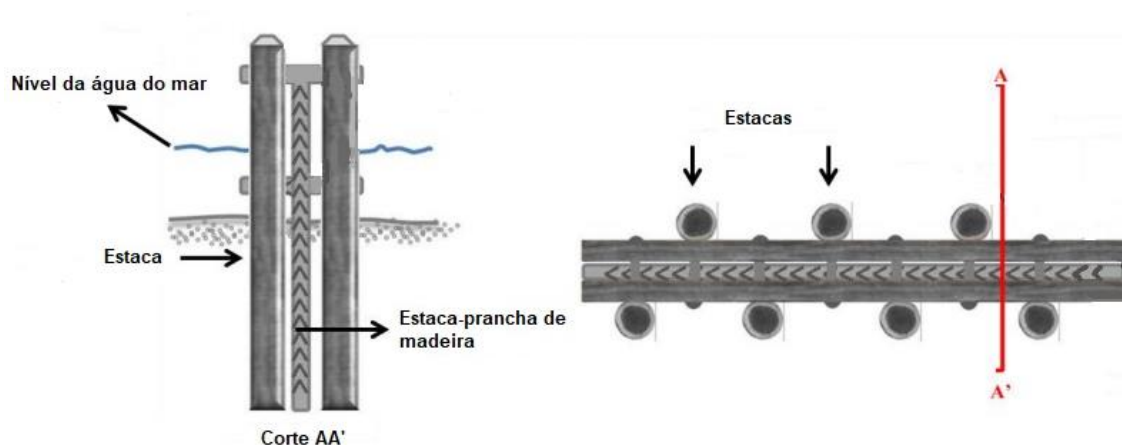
Perfil transversal e configuração em planta de um esporão vertical em madeira (Averini Rodeia, 2014 - Adaptado).
